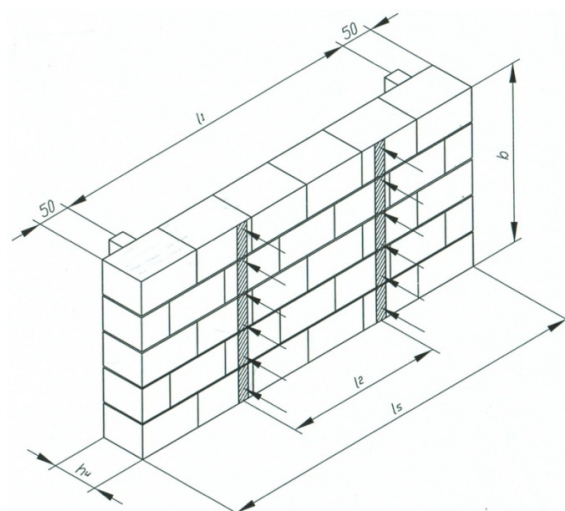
Схема испытания кладки при изгибе по перевязанному сечению.
